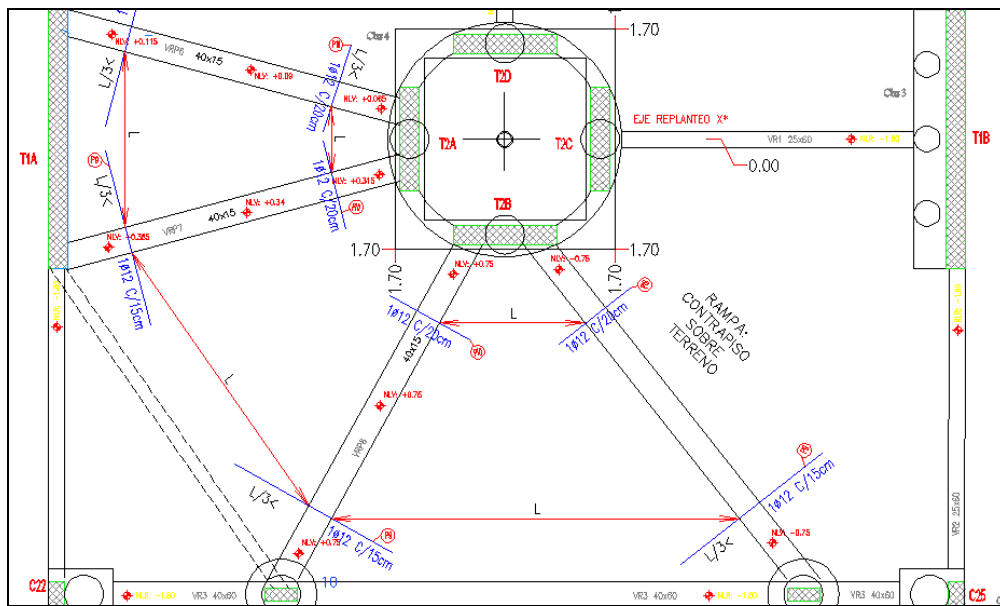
Detalle de armadura superior de refuerzo en apoyos de la losa de la rampa de circulación.
